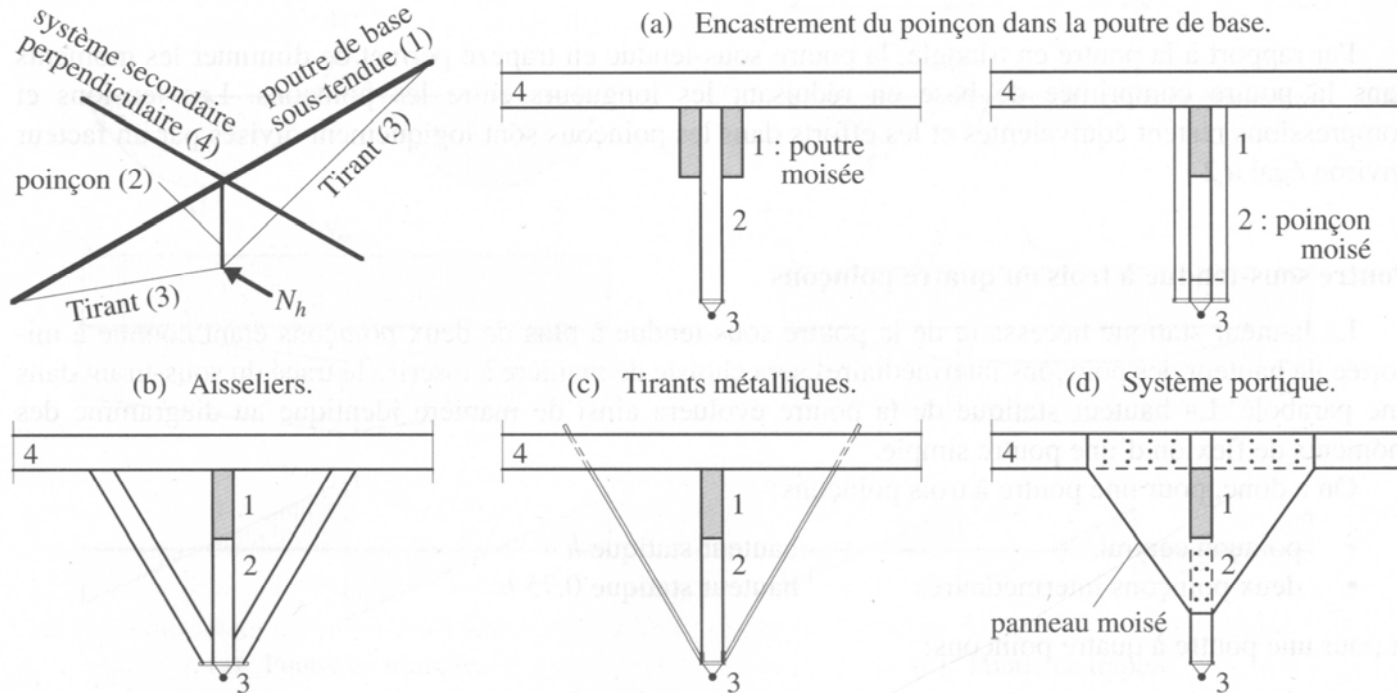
Exemples de systèmes de stabilisation perpendiculaires au plan des poutres sous-tendues.
